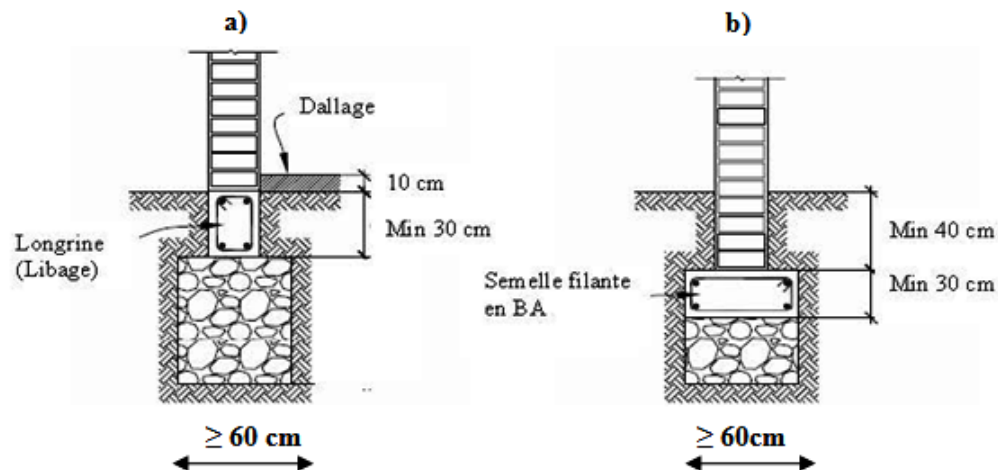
Fondations: a) Fondation en maçonnerie de pierres et longrine en BA; b) Semelle filante en BA
